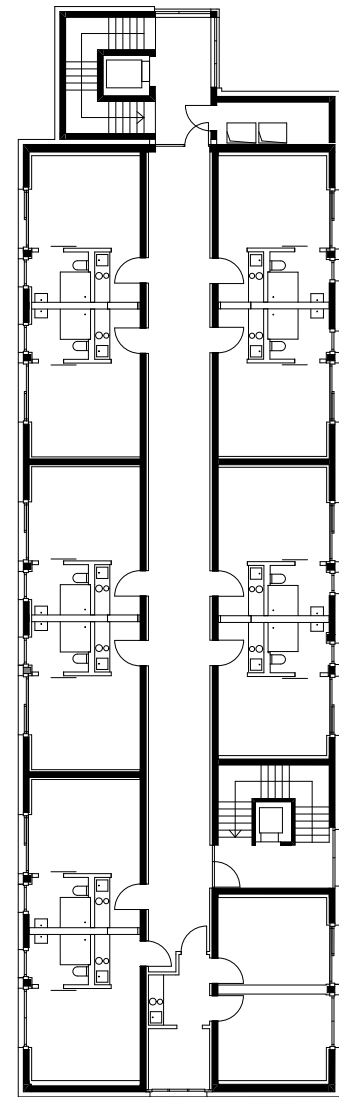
Grundriss Regelgrundriss, M. 1:300 [Quelle: BF Vario]
